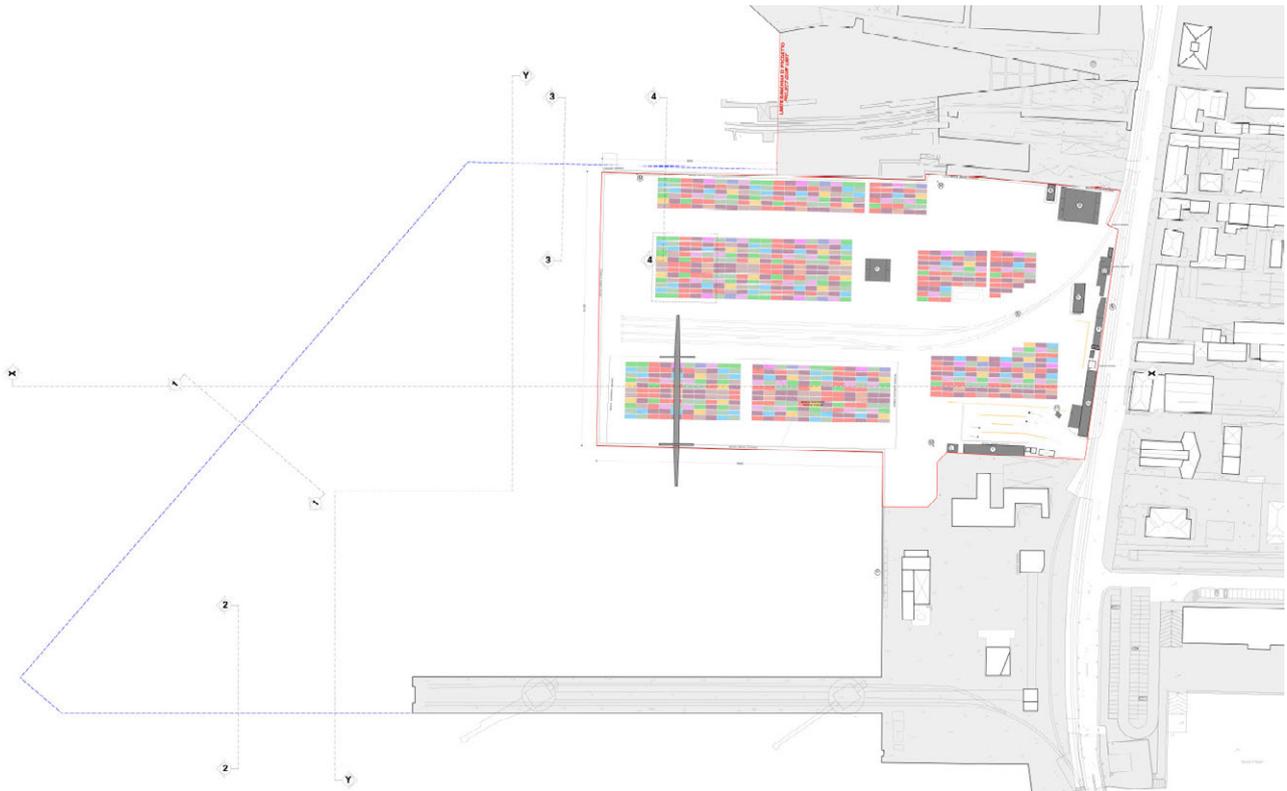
Terminal del Golfo: planimetria dello stato di fatto
